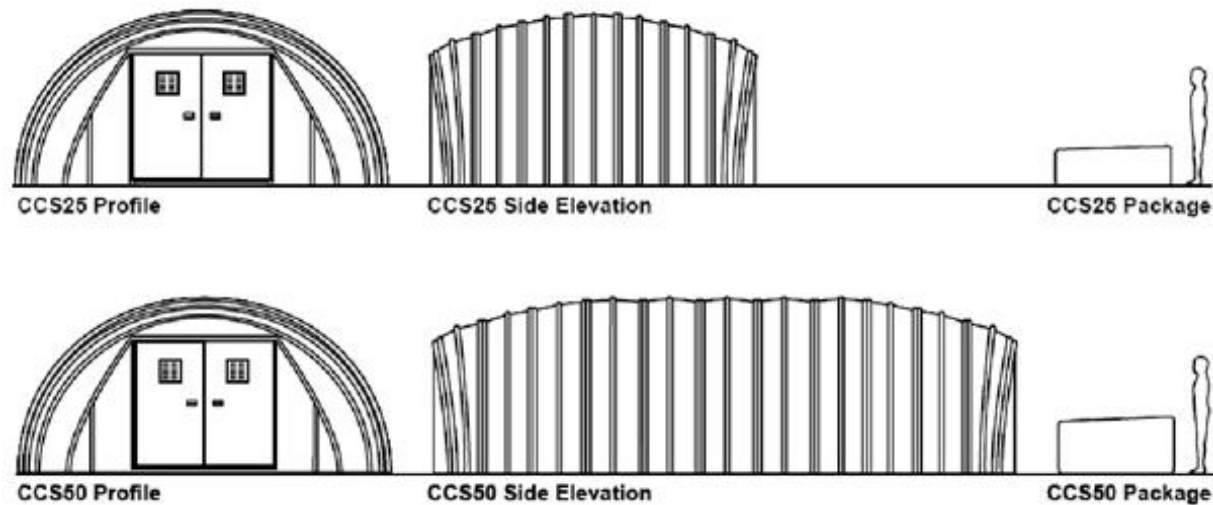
Fachadas. Fuente: Concrete Canvas, <http://www.concretcanvas.com>
